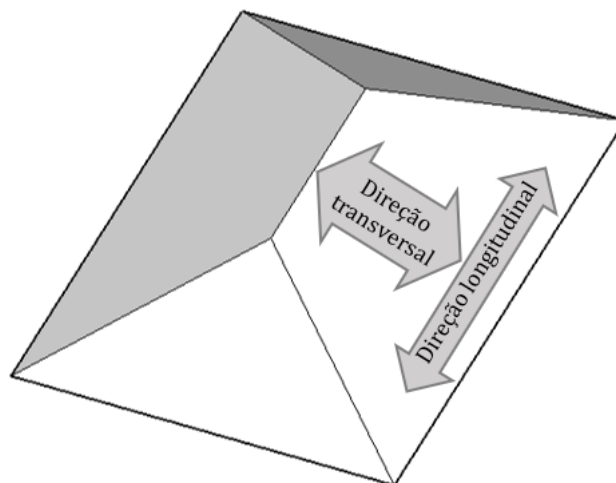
Direções longitudinal e transversal adotadas na cobertura
